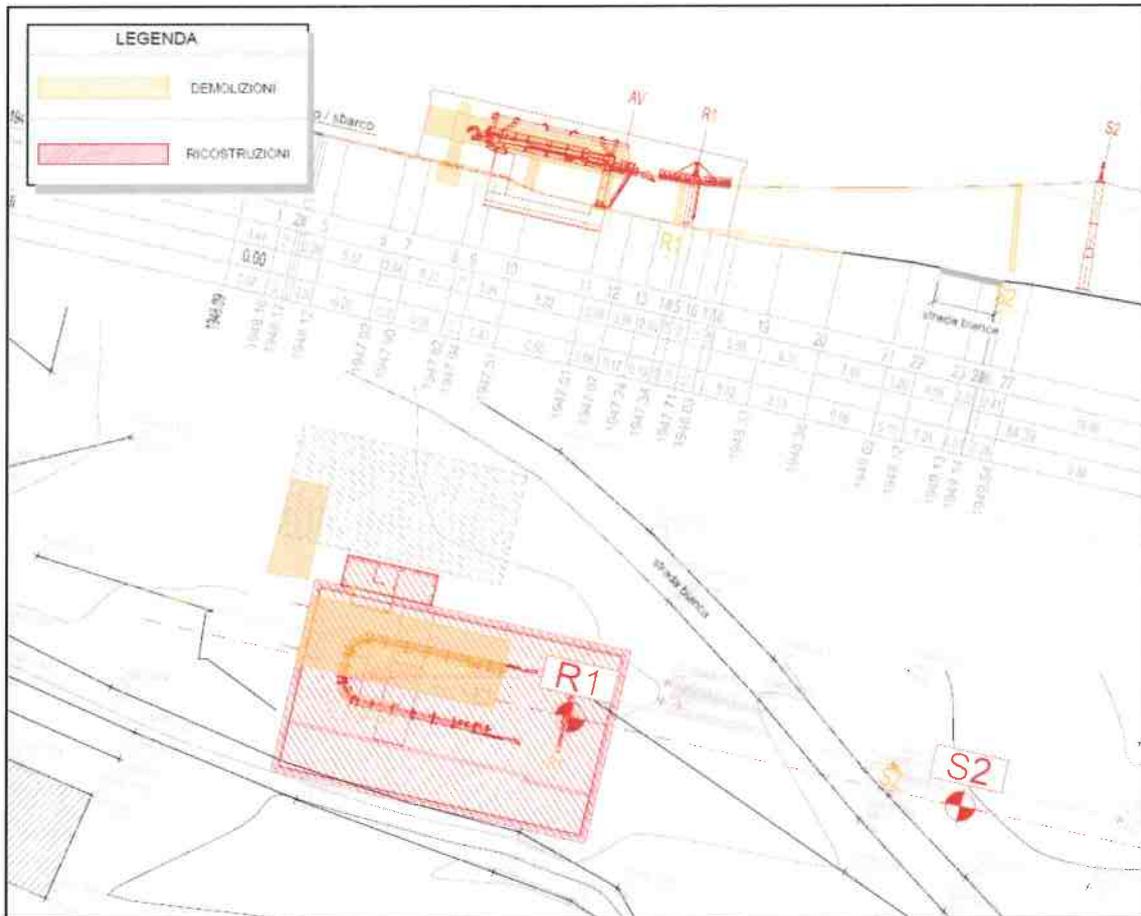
Ricostruzione e demolizione della stazione di valle, in pianta e in sezione (da elaborato 6.1).
